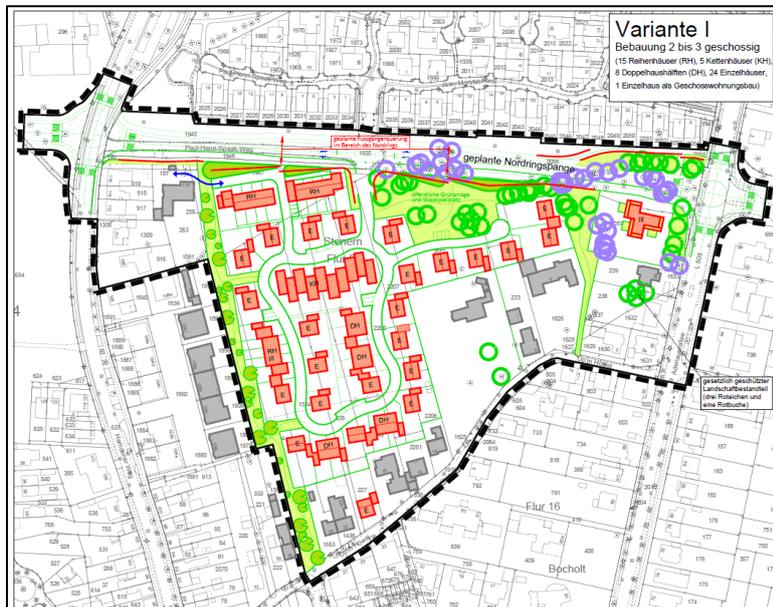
Bauungsvariante 1 zum Bebauungsplan 10-7
